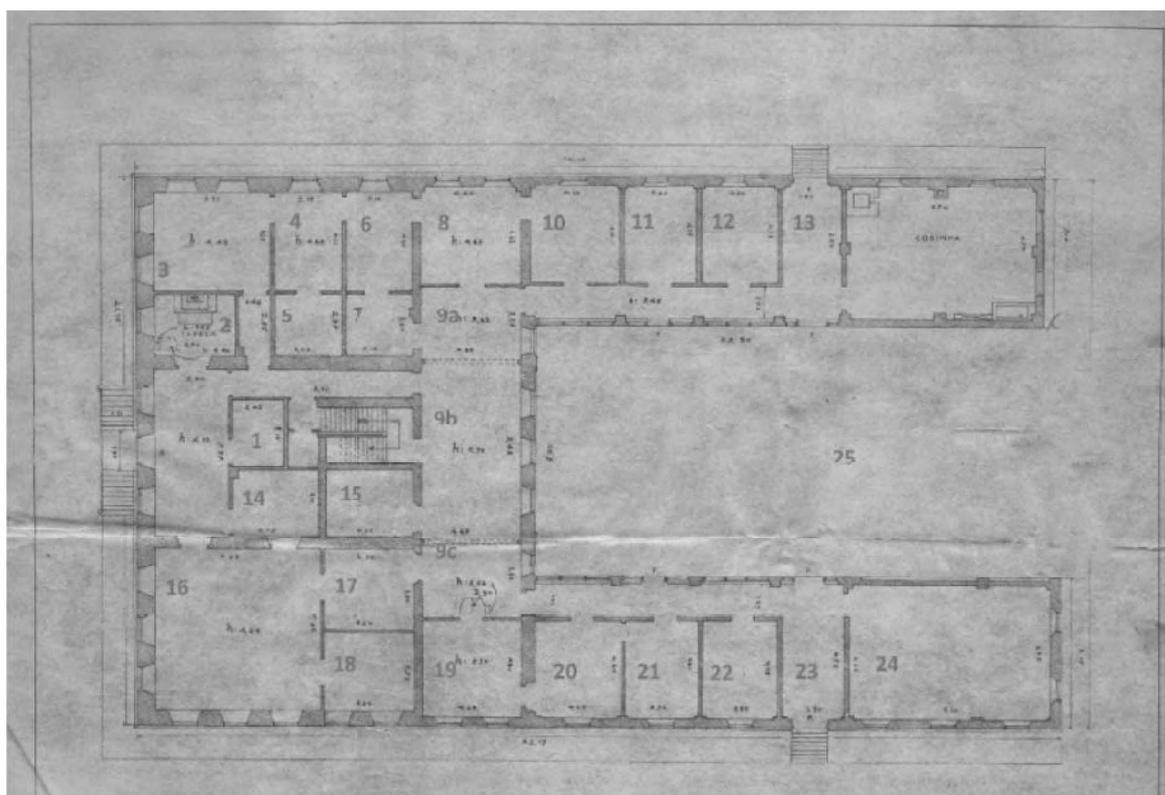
Planta Baixa do Térreo. <sup>22</sup>
